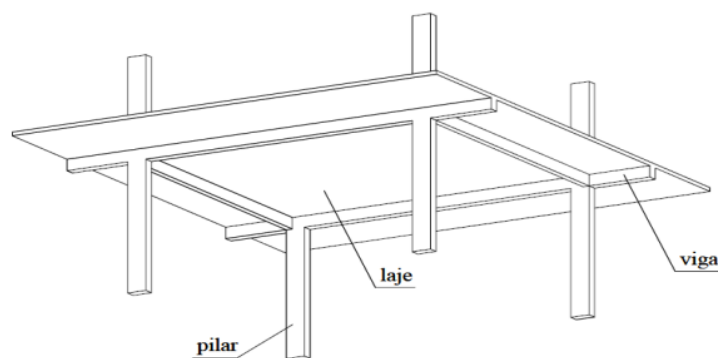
Perspectiva de um pavimento de concreto armado. (SILVA., 2005)
